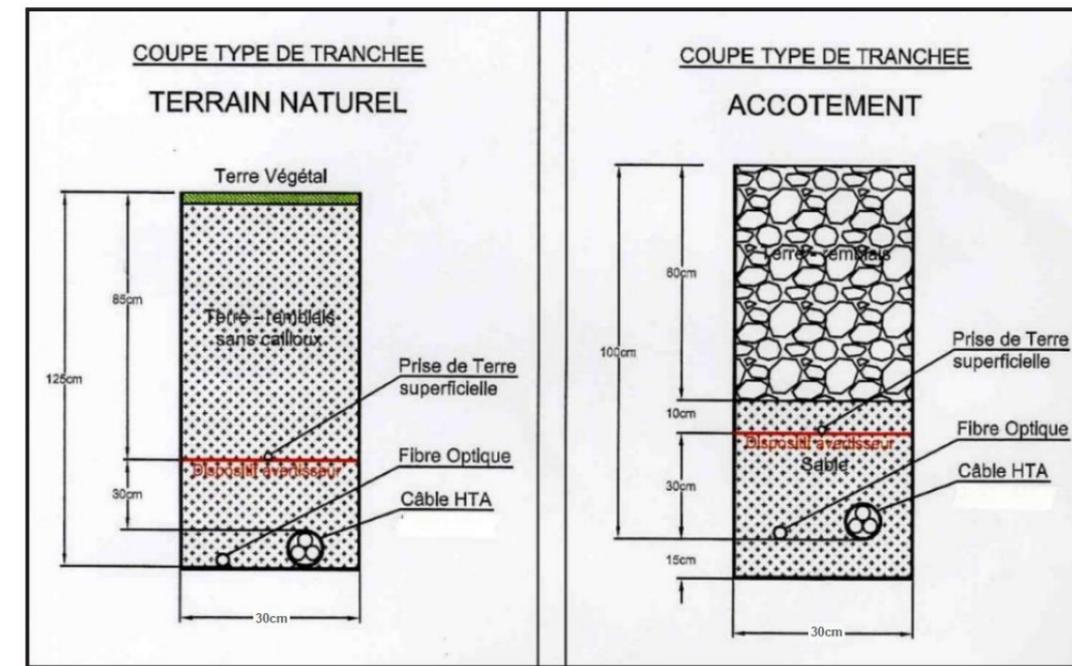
Coupe type d'une tranchée pour le raccordement électrique externe
